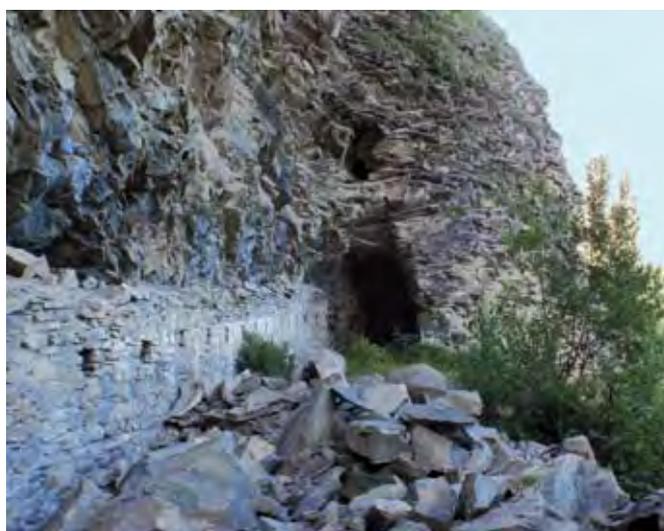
Quinta galleria in roccia con resti del tunnel paravalanghe (Foto Bessone L.).
